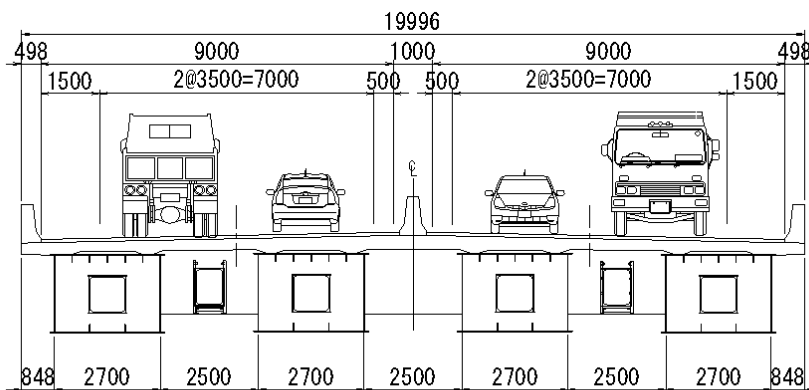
鋼 I 桁断面主桁の検査路設置例
